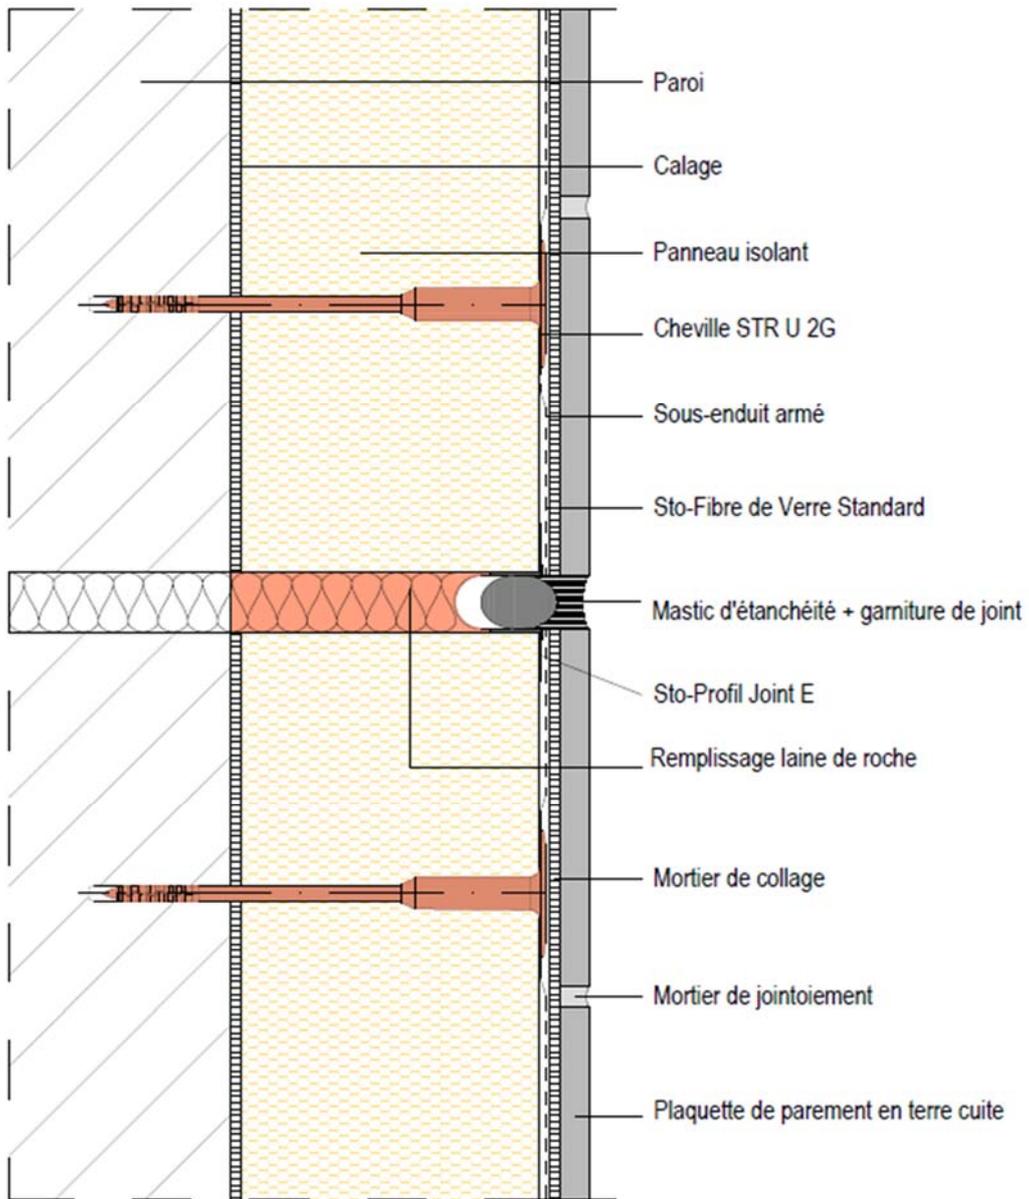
Utilisation de Sto-Profil Joint type E et mastic d'étanchéité (angle)
